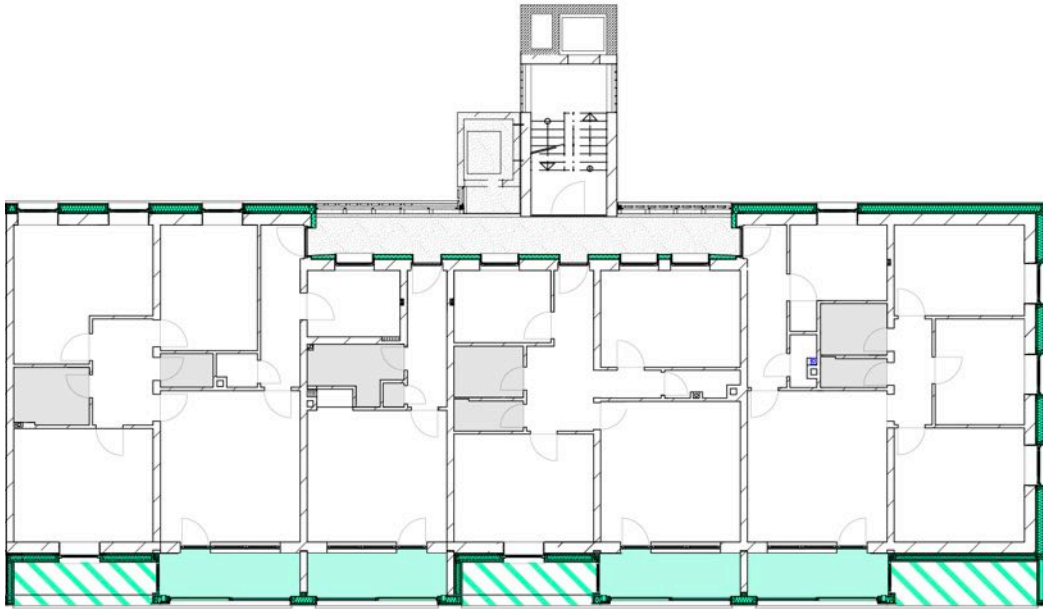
Grünthenstraße 30-36. Floor plans (1:250)
